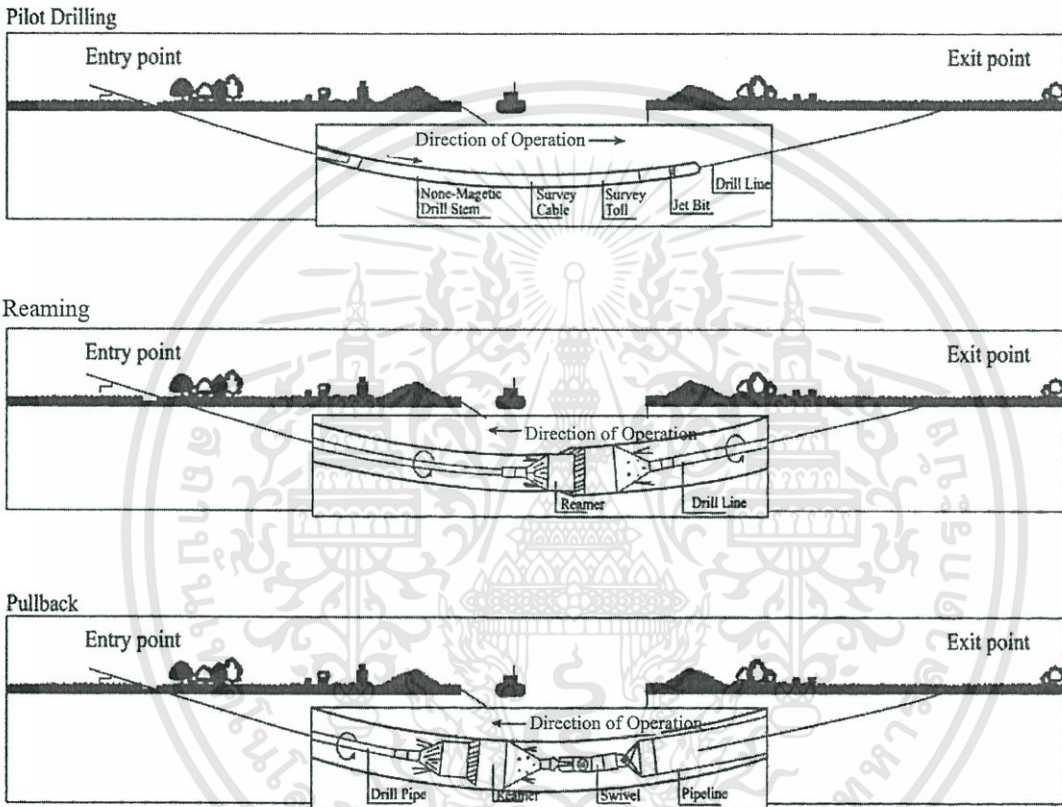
เครื่องมือ Horizontal directional drilling (HDD) (www.paneltec.com.au)
